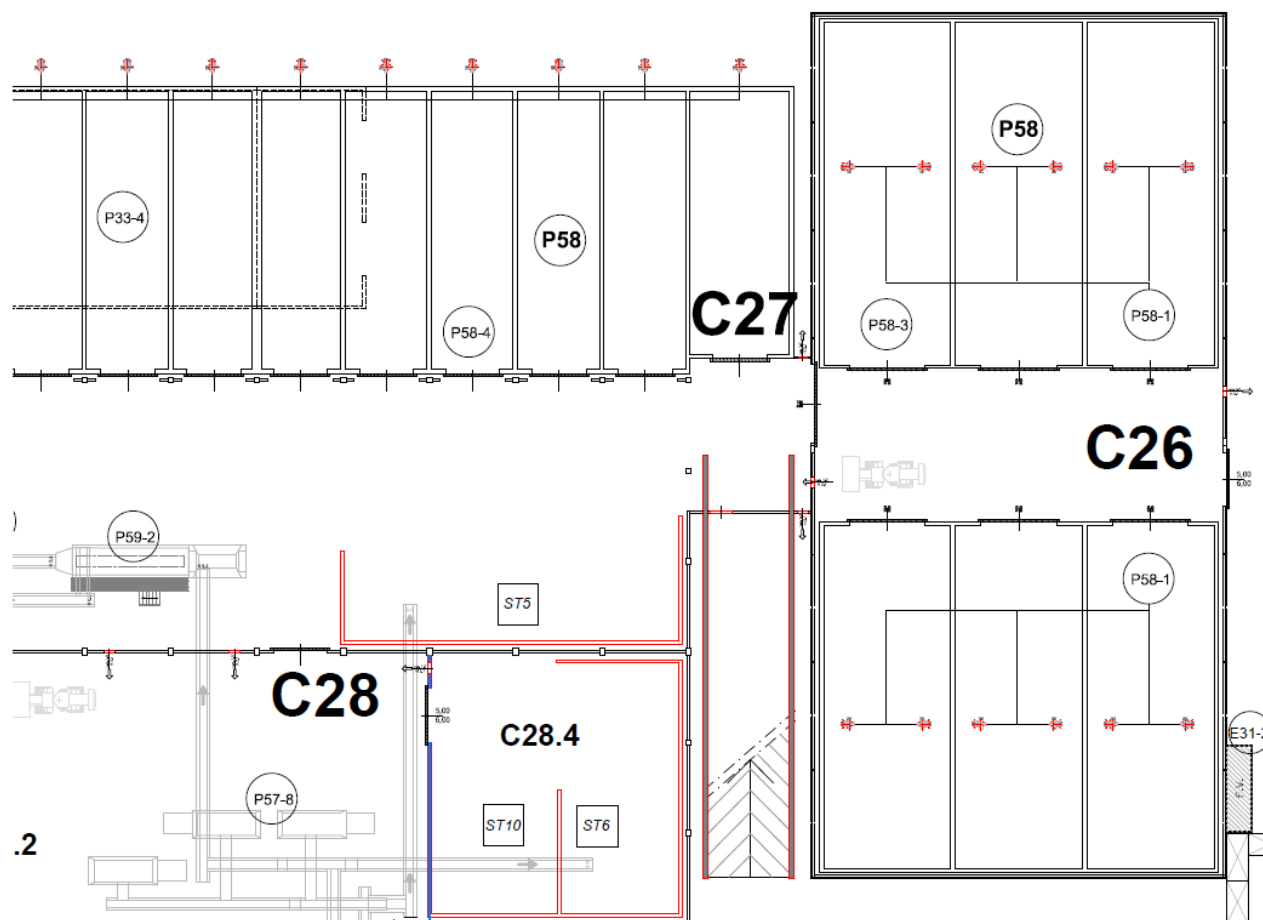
Sezione di stabilizzazione aerobica P58-3
